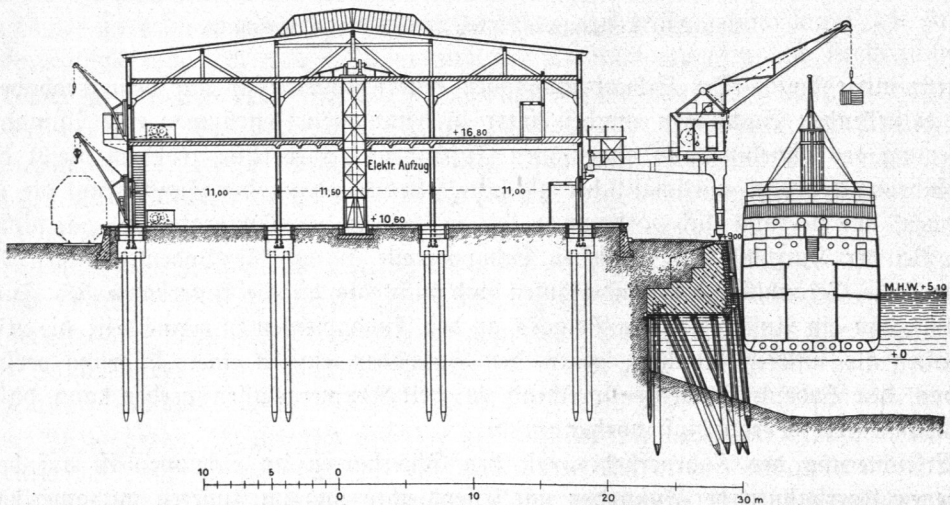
Fruchtschuppen C am Magdeburger Hafen, Querschnitt.
